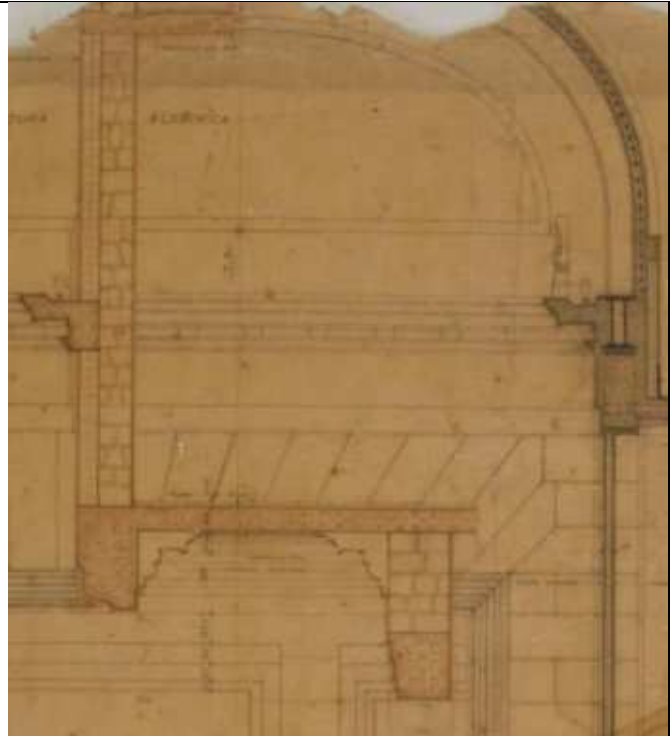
A la derecha detalle de los distintos métodos constructivos representados en el plano del arquitecto Navarro. (Navarro, 1932). En el acercamiento es posible ver bloques, piedra, concreto armado, perfiles metálicos, apliques de yeso.
